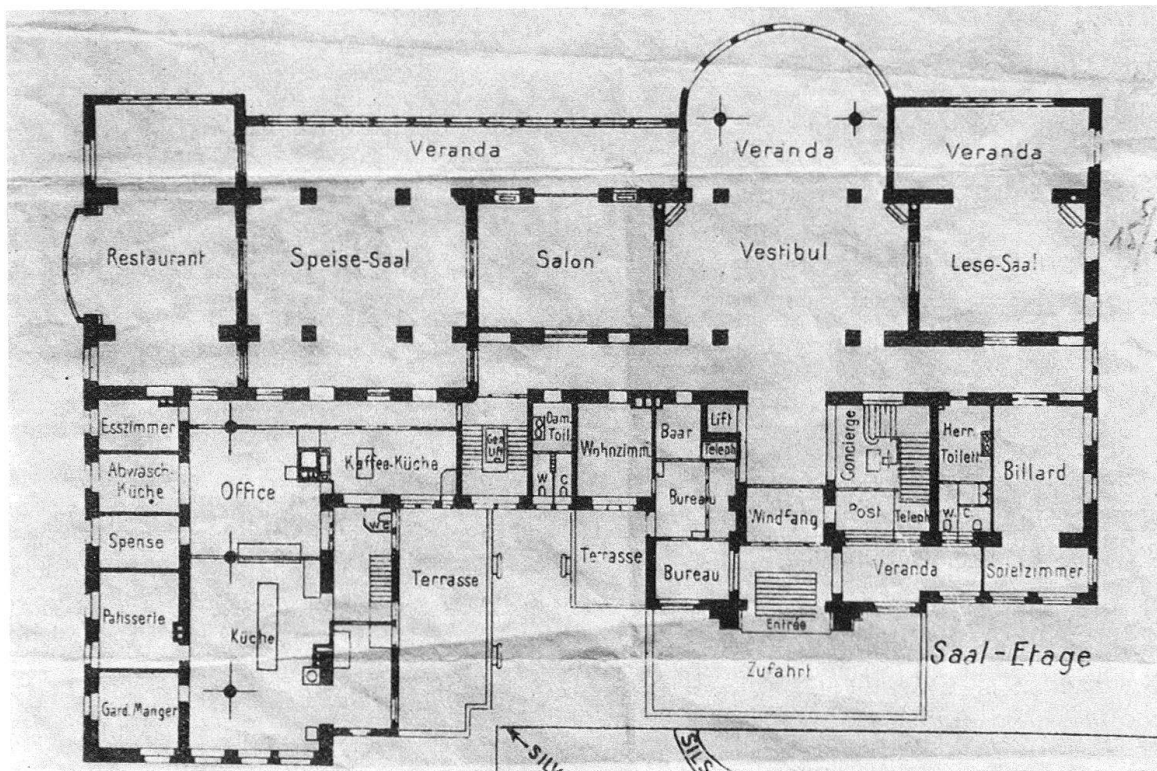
Sils Maria. Hotel Waldhaus, Grundriss der Saal-Etage
